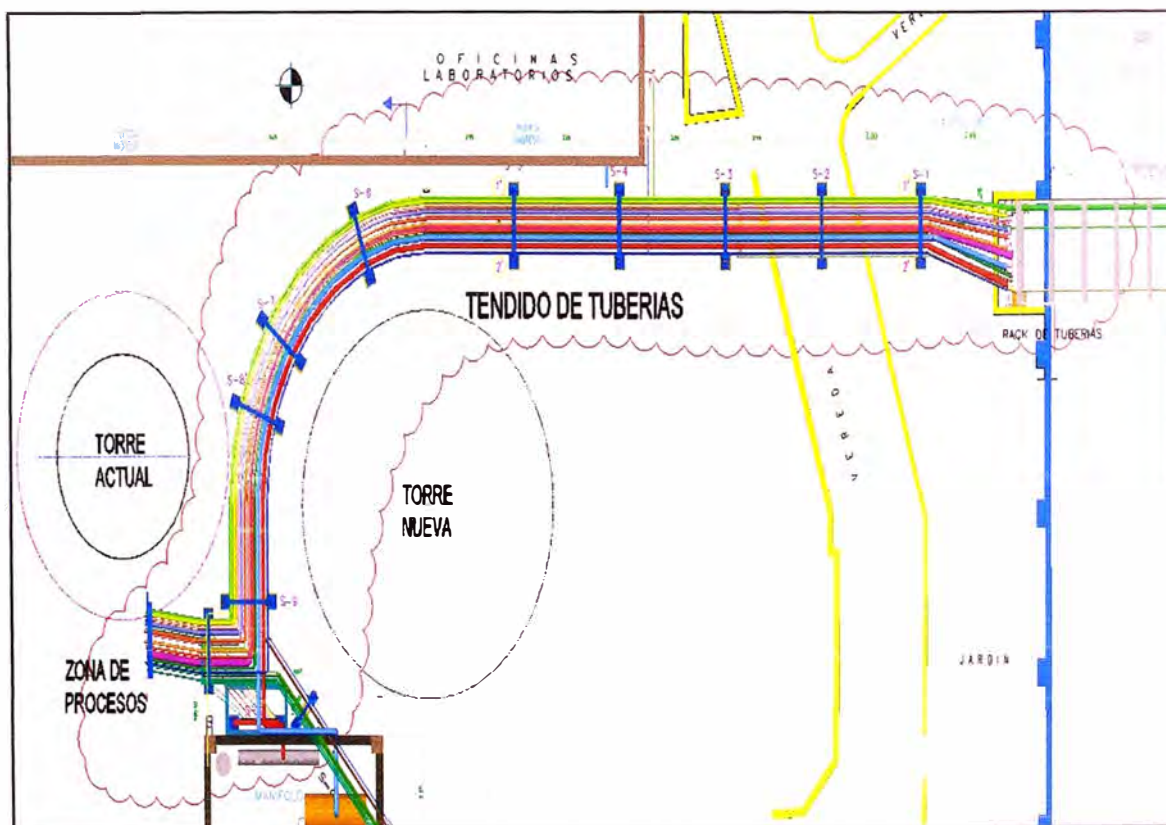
Vista de Planta: Proyección de tendido de tubería
